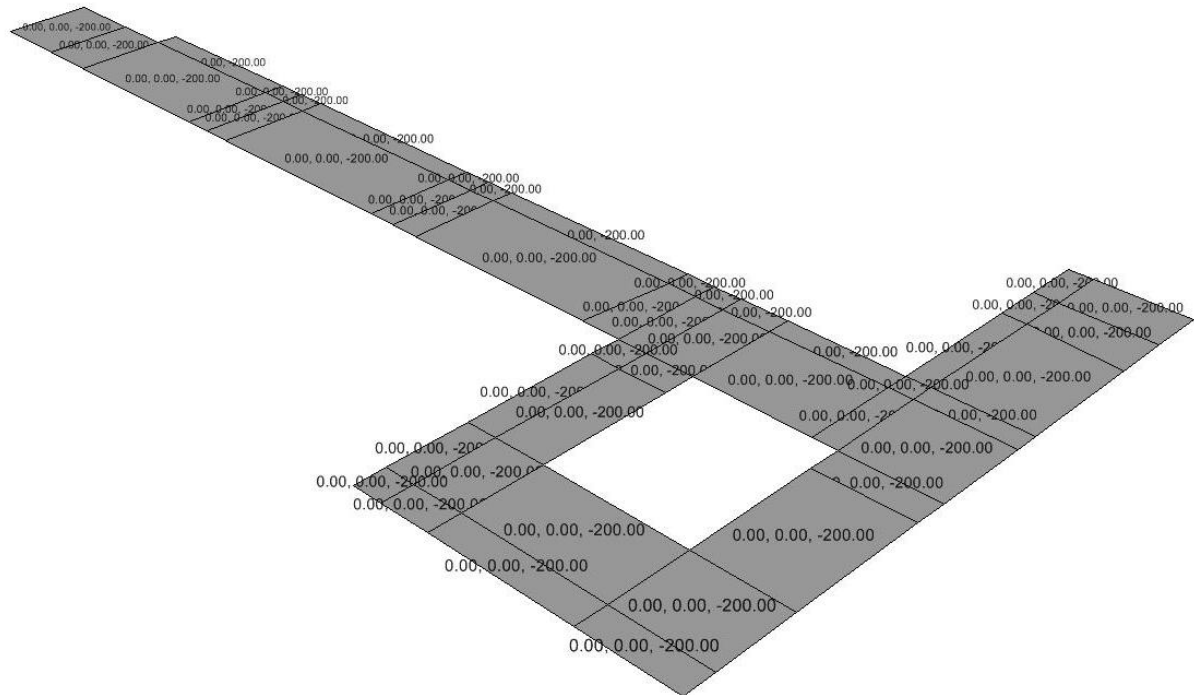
Asignación de Carga viva sobre elementos de losa de cubierta
